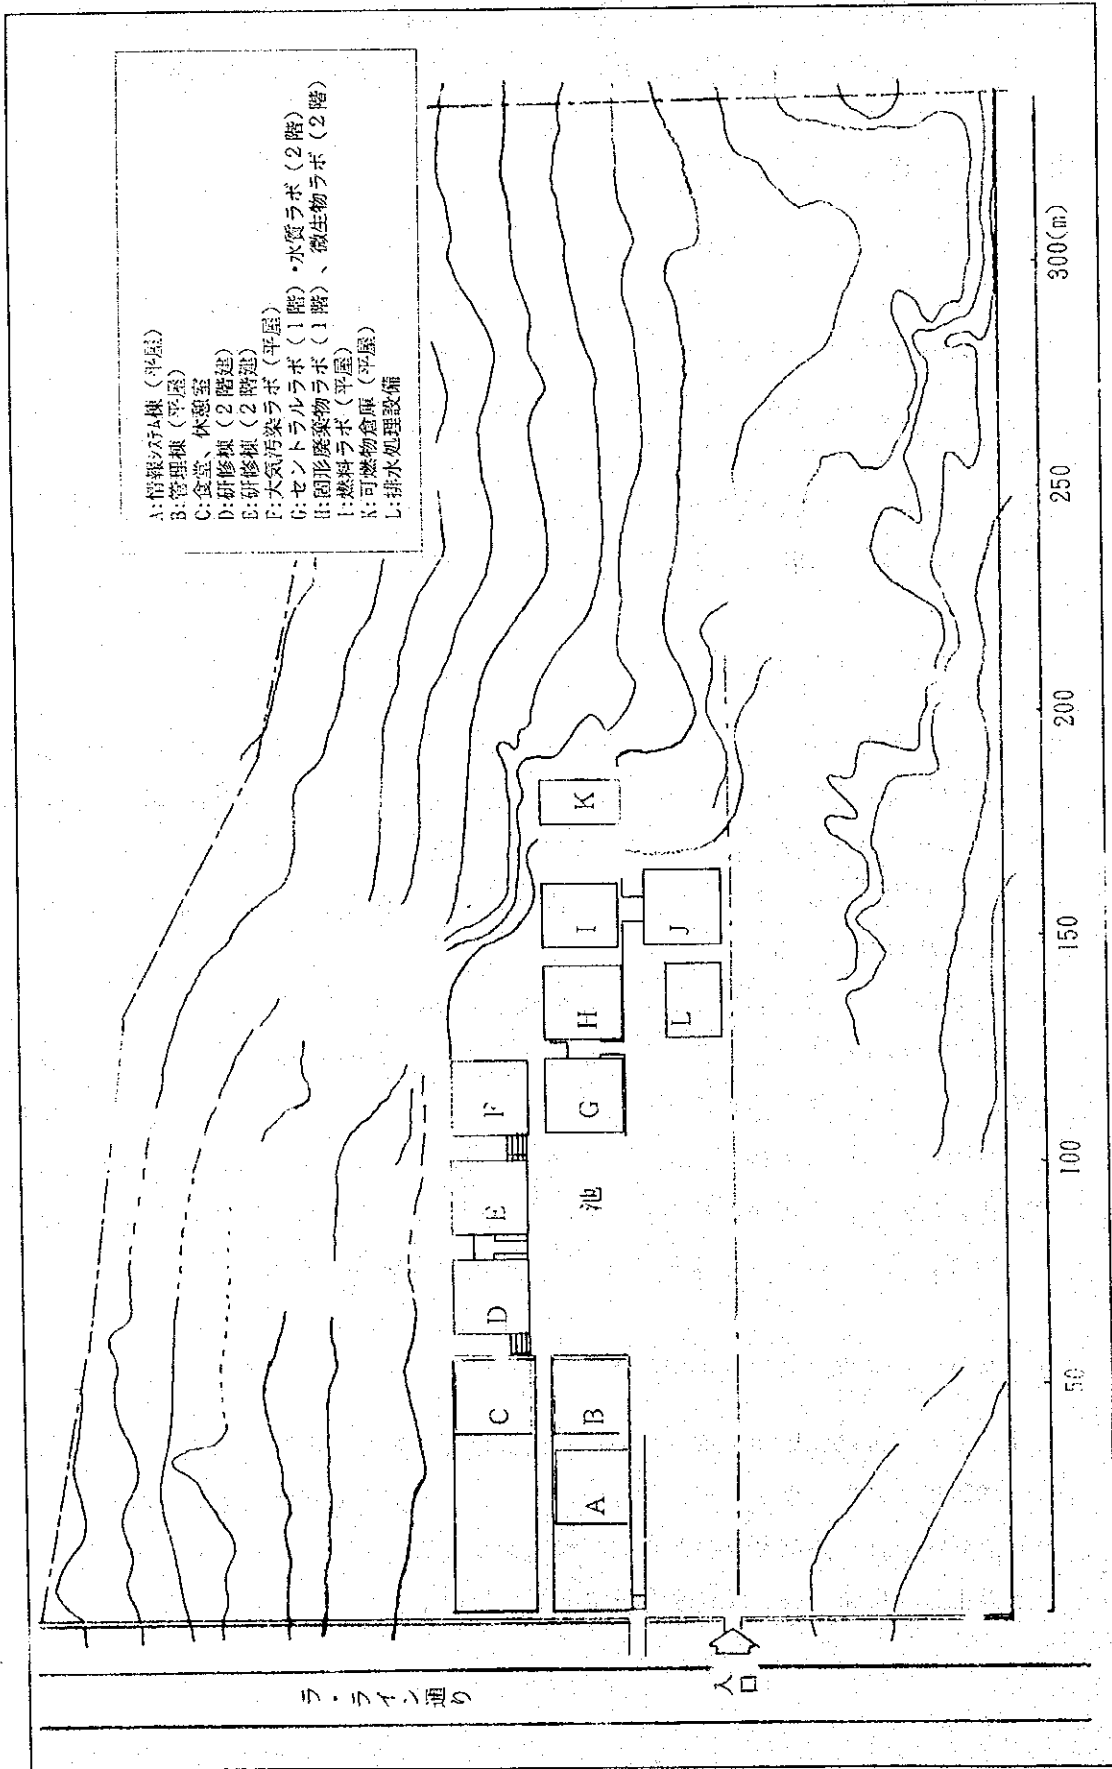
チリ環境センター平面図 (チリ大学ラ・レイナキャンパス)
